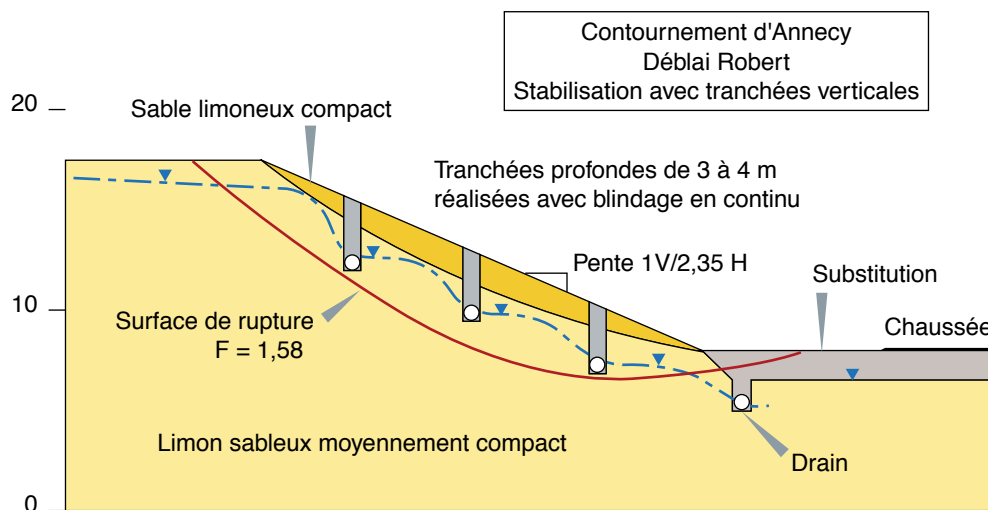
Profil de calcul de stabilité permettant de caler la disposition des tranchées drainantes.
